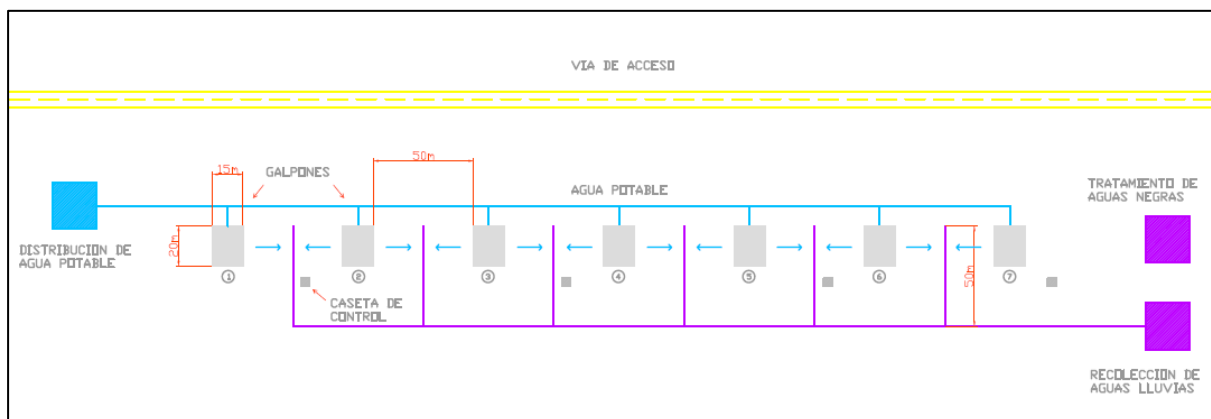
Esquema propuesto por los dueños de la hacienda para el proyecto.
